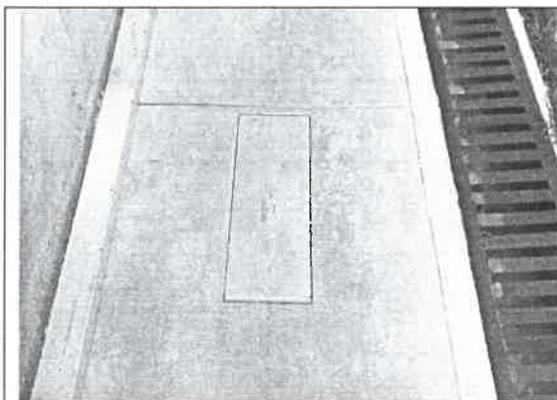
Vista muestra cuarteamiento y descascamiento del concreto en la pared de concreto del drenaje pluvial,
